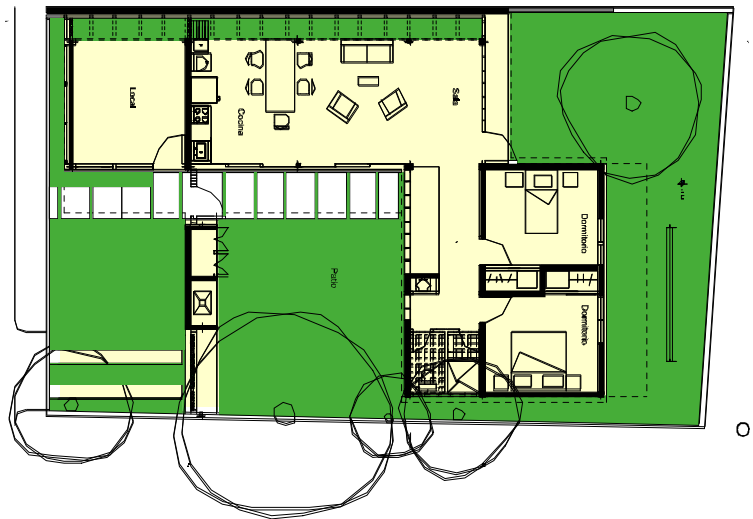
Planta de vivienda bioclimática prototipo VBP-1.
